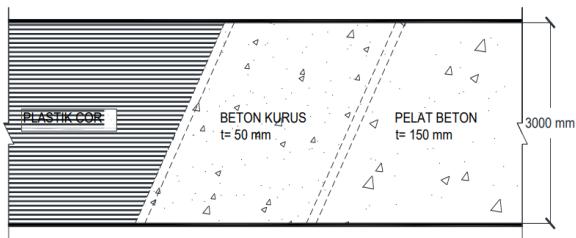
Long Section STA 0+000 sampai STA 0+250 Jalan Kapten Piere Tendeen
